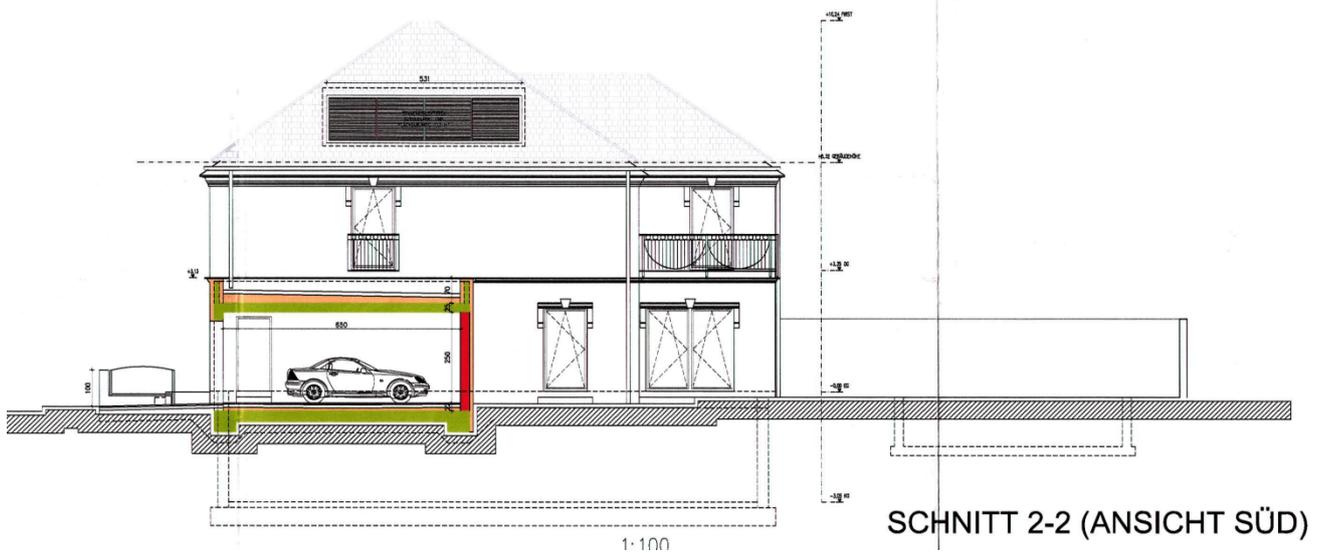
Schnitt 2-2 (Ansicht Süd) | Einreichplan | Pongratz Bau GmbH (gezeichnet von Dipl.-Ing. Gassenbauer) | 01.04.2010
